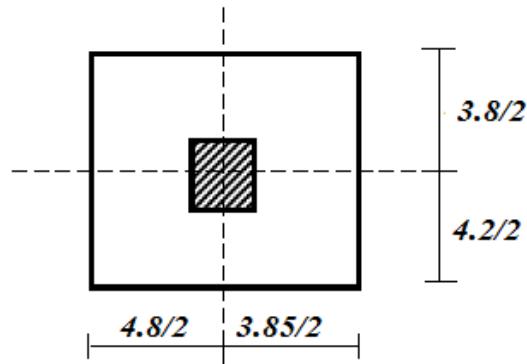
La section la plus sollicitée du poteau rectangulaire
